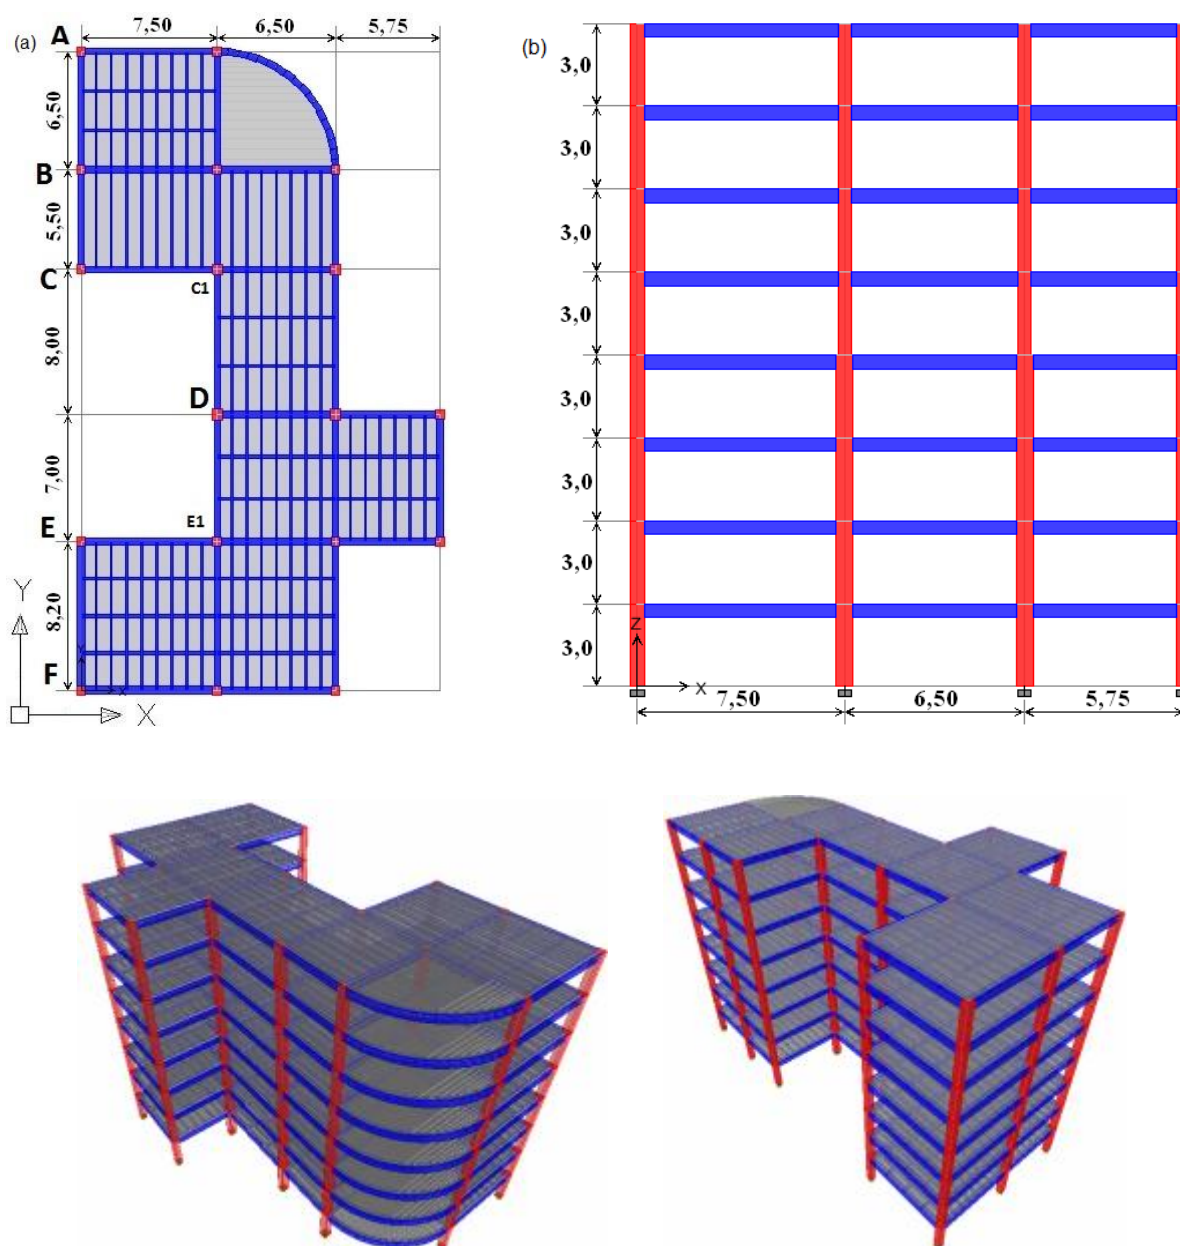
Vista em planta baixa e em corte da estrutura e modelo isométrico da estrutura.
